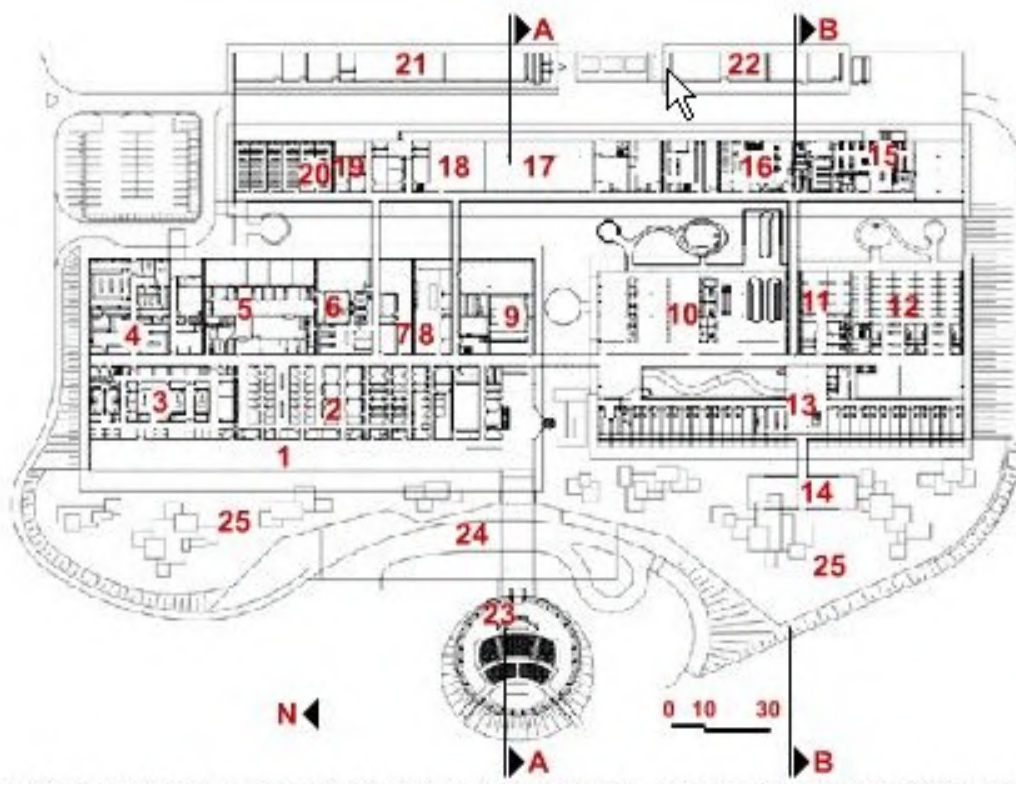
Planta baixa Hospital Rede Sarah - RJ
